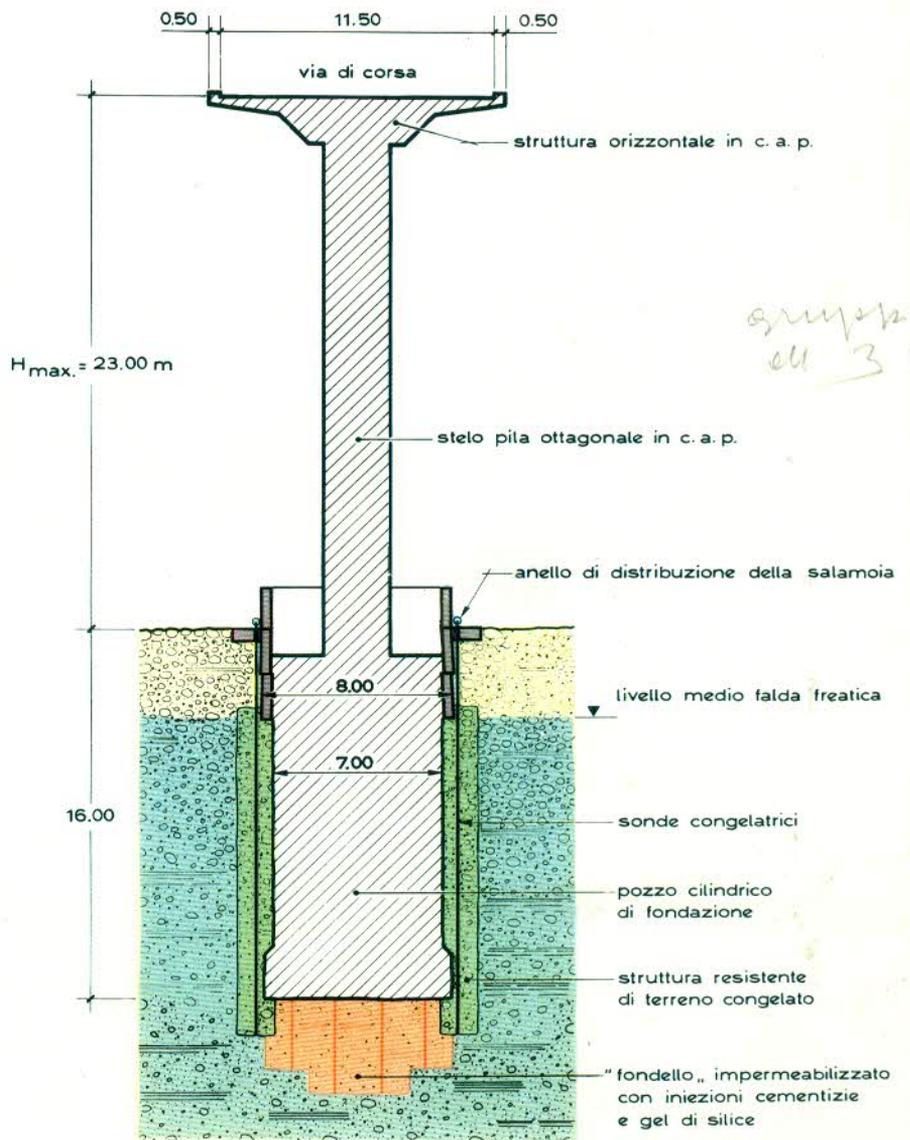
Schema tipo dell'intervento di congelamento. Sezione trasversale di un pozzo □ Freezing treatment scheme. Cross section of a foundation well
